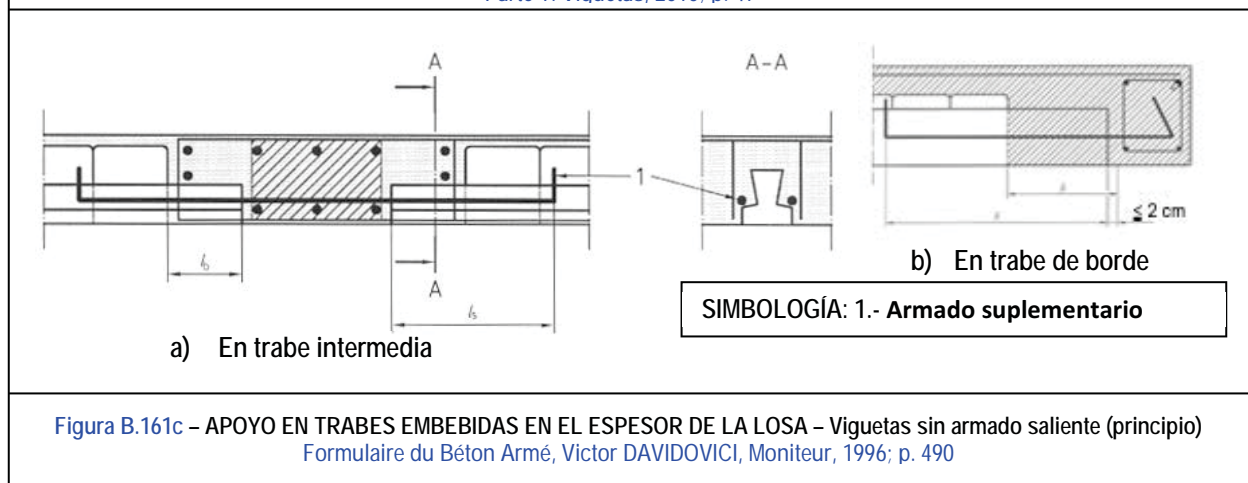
APOYO EN TRAVES EMBEBIDAS EN EL ESPESOR DE LA LOSA – Viguetas sin armado saliente (principio)
